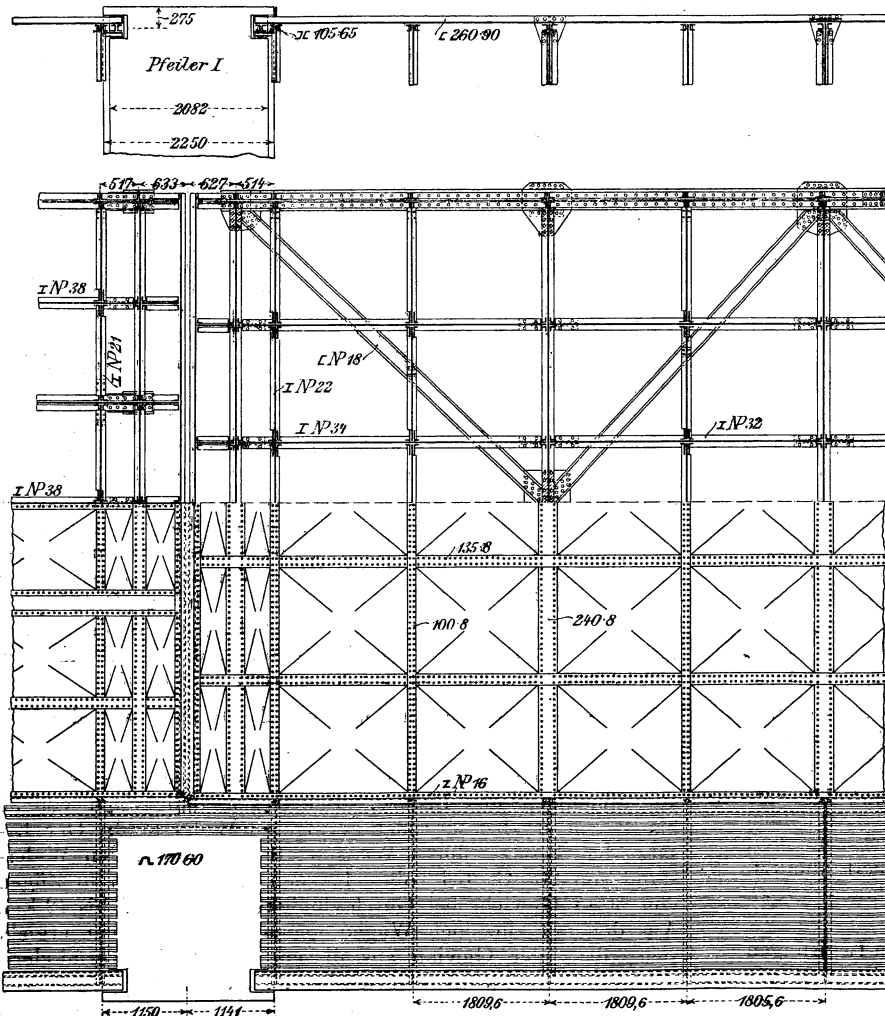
und 37. Horizontalschnitt und Grundriss der Fahrbahn.
